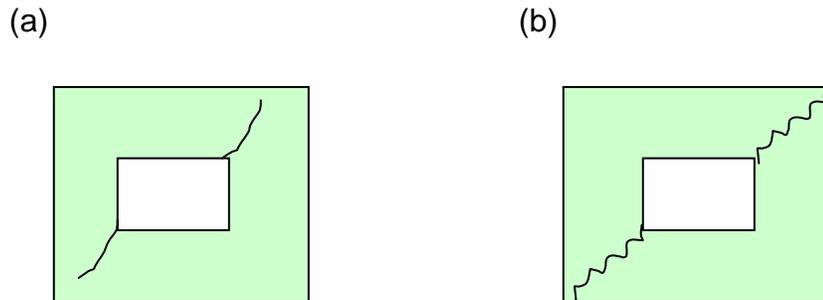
Tipos de fissuras em alvenarias devido a movimentações diferenciais das fundações (SILVA, 1993).
